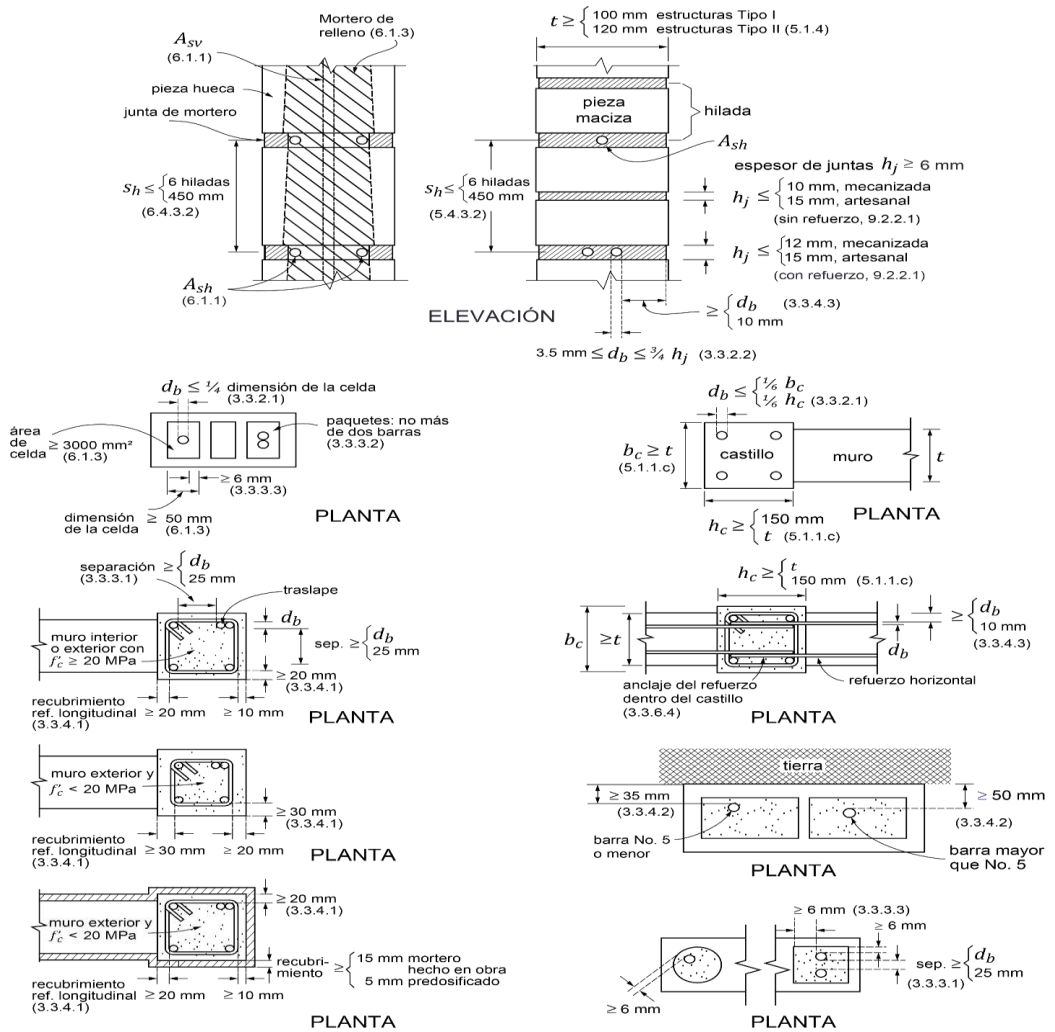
Tamaño, colocación y protección del refuerzo
